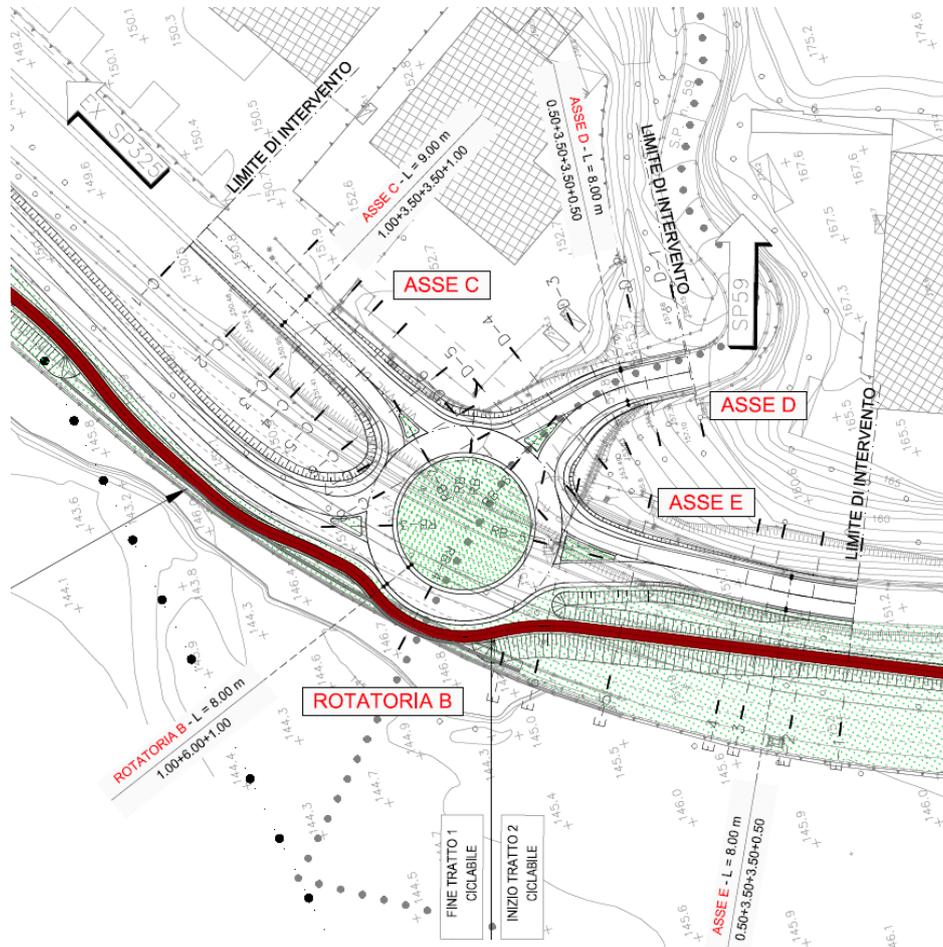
Stralcio planimetrico intersezione rotatoria B
